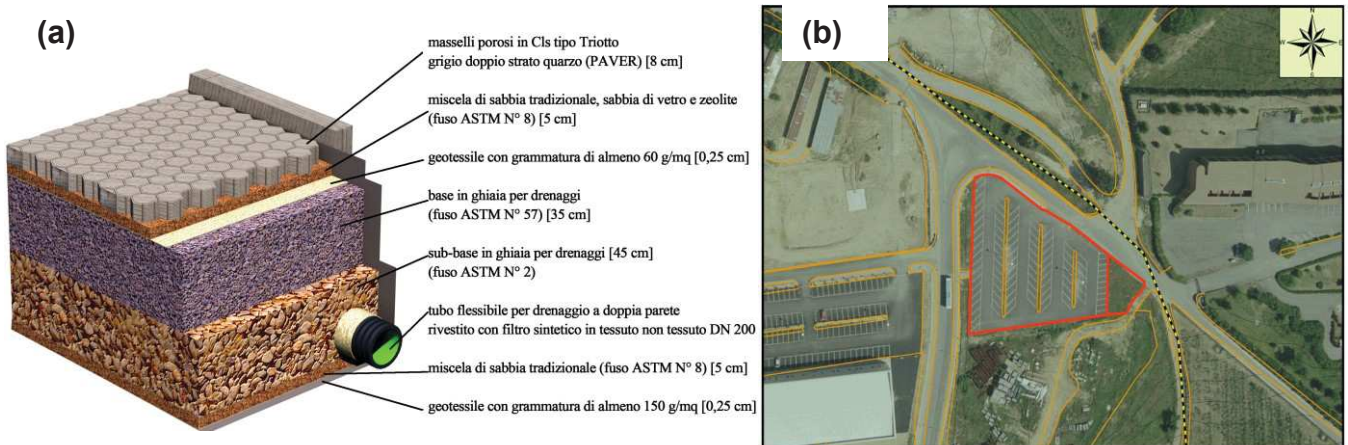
Descrizione del sito sperimentale: nel pannello (a) è riportata la stratigrafia della pavimentazione drenante, il pannello (b) illustra invece la posizione planimetrica della stessa installazione sperimentale (Piro ed. 2015).
